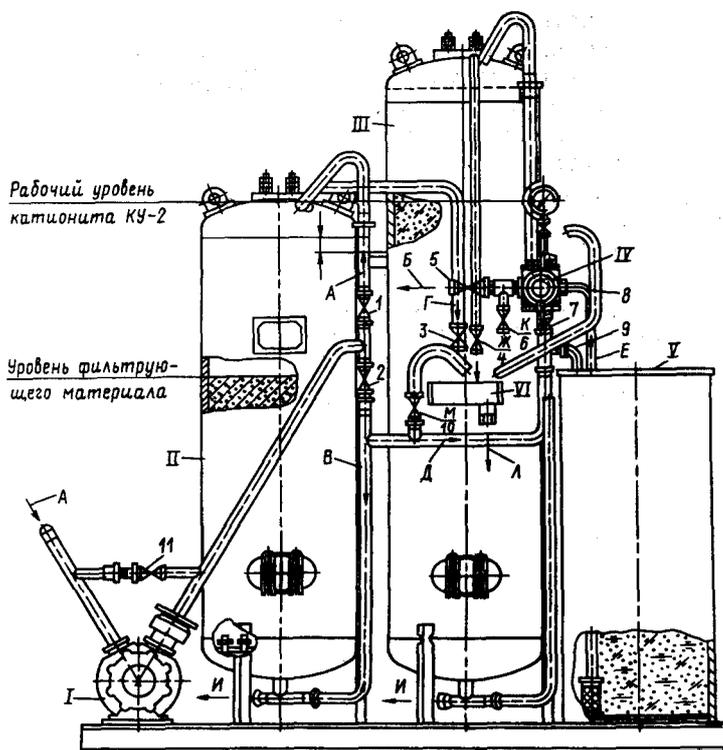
Блочная водоподготовительная установка ВПУ-1,0-К с осветлительным фильтром:
